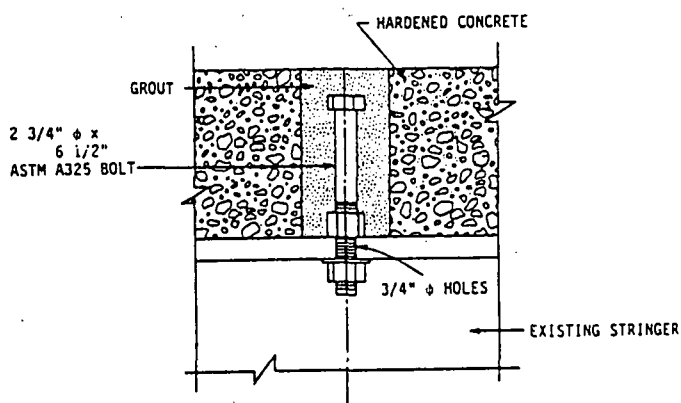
高力ボルトをずれ止めとして用いる場合の詳細
